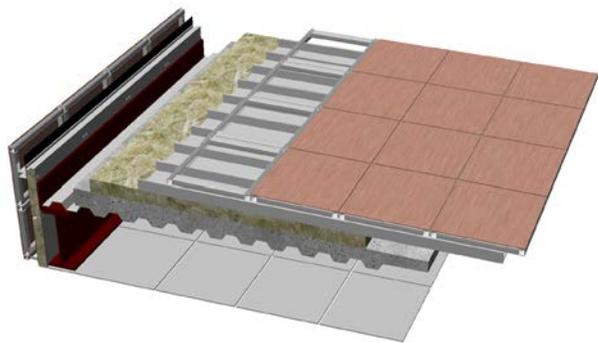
Detaillierte 3D-Darstellung des Dachaufbaus
